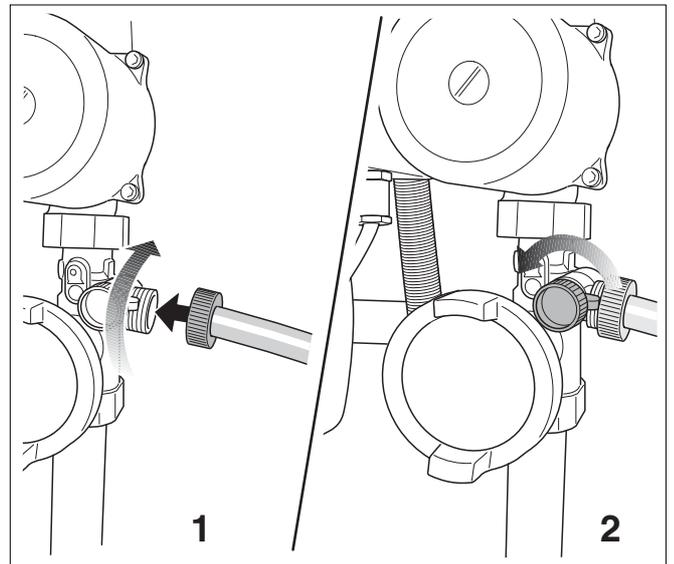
Collegare la tubazione / aprire il rubinetto di carico e scarico
